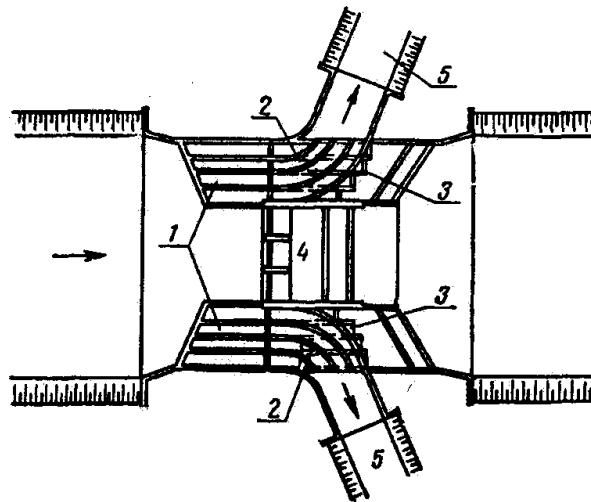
Фронтальный двухъярусный водозабор:
